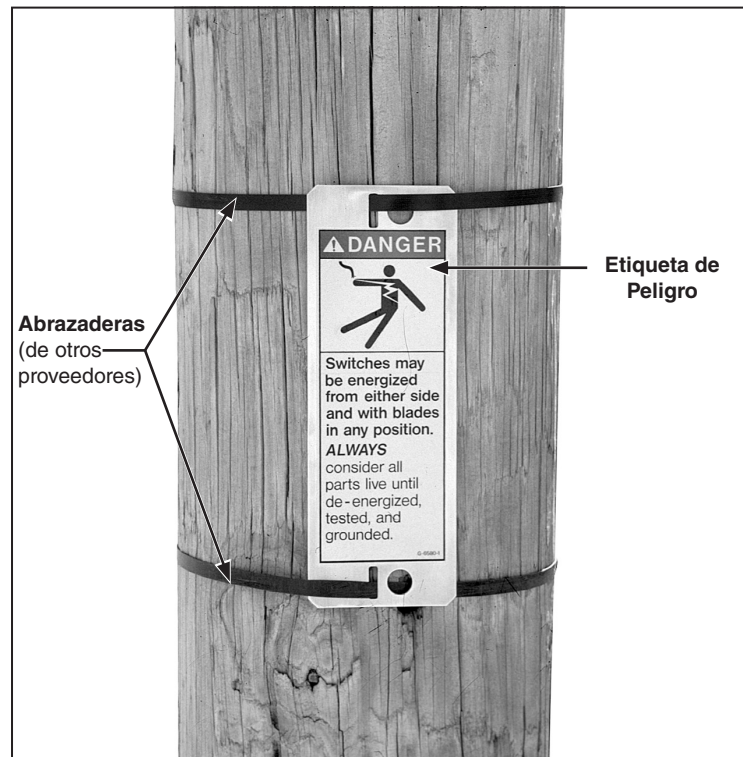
Colocación de la etiqueta de peligro en el poste o estructura.
